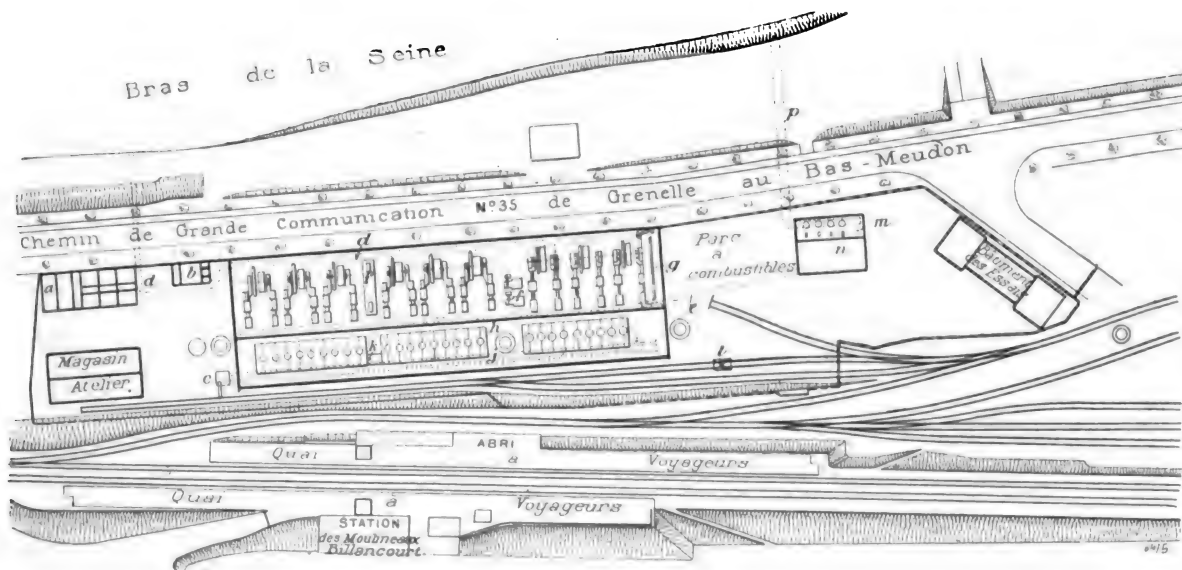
Usine des Moulineaux. Plan d'ensemble.
